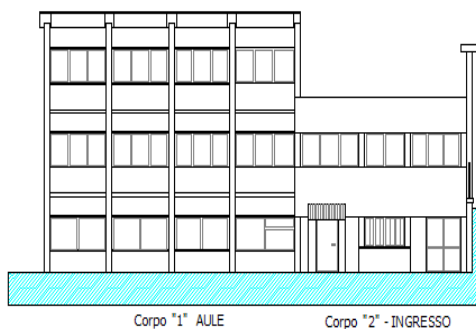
Prospetto Ovest – Sezione 1-1 – (disegno fornito dall'ing. A. Giardi)
